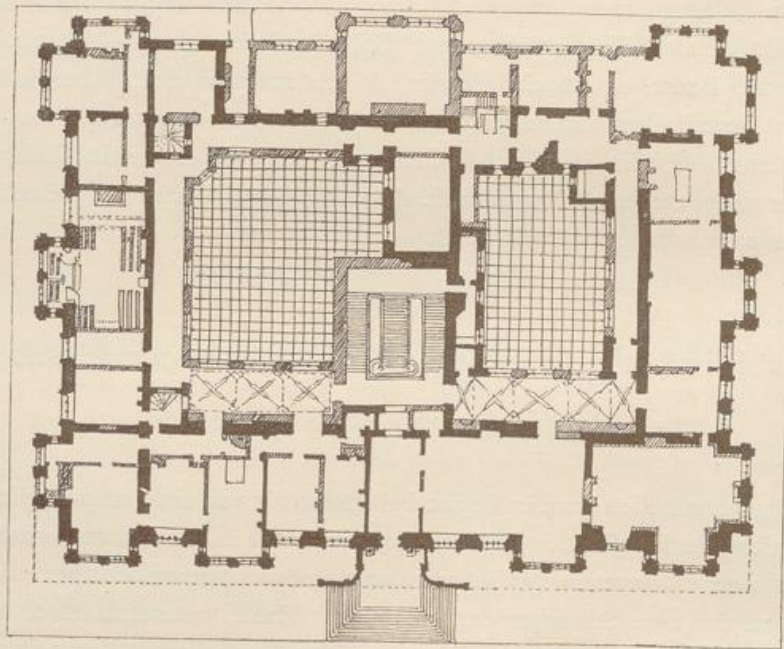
Longleat House. Grundriss. (n. Britton.)
